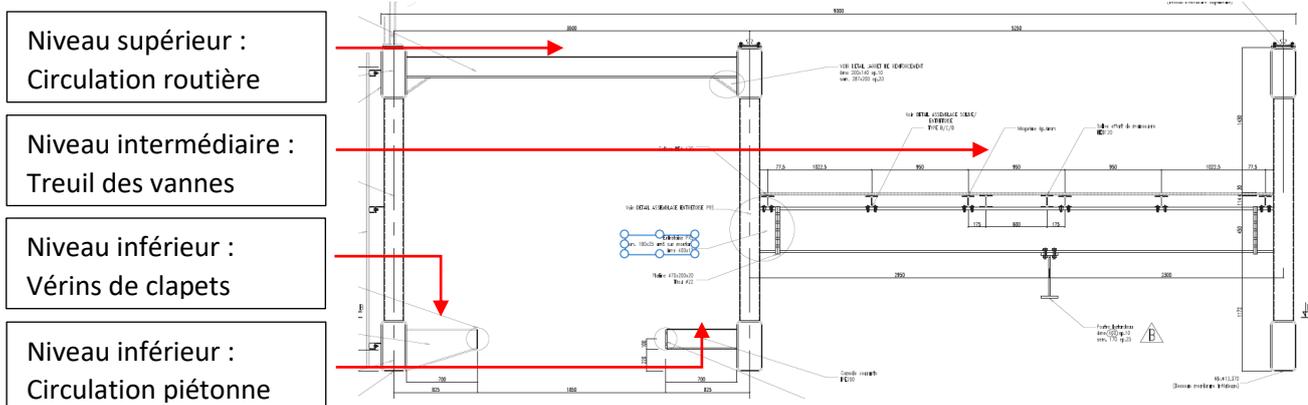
Coupe en travers aval-amont du nouveau pont (amont à droite ; extrait plan Berthold)
